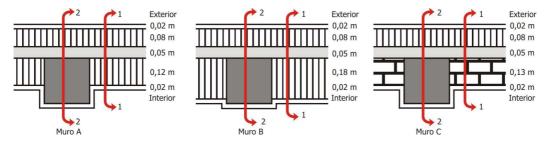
Muros dobles propuestos para cerramiento vertical exterior (sección 1 muro y sección 2 puente térmico)
